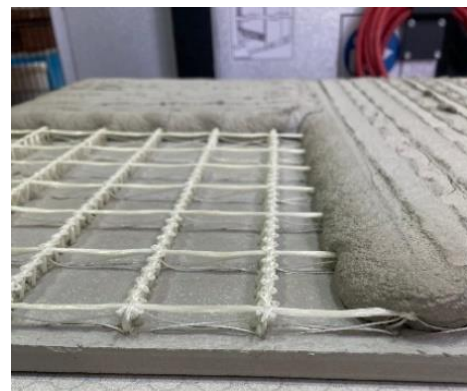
Oberflächenstrukturierung auf bewehrter Grundplatte mit Druckportal (Foto: Sebastian Heine)
